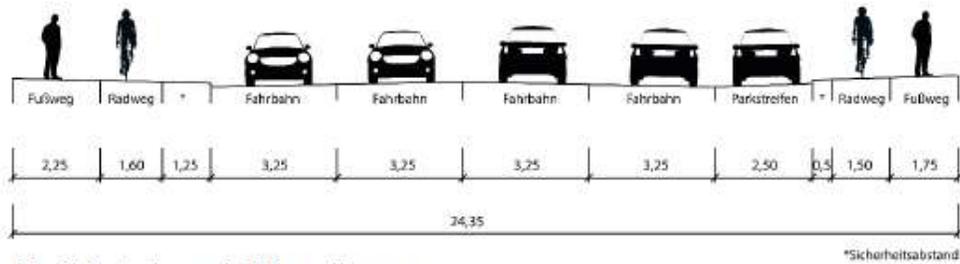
Bestandsquerschnitt Berner Heerweg.
